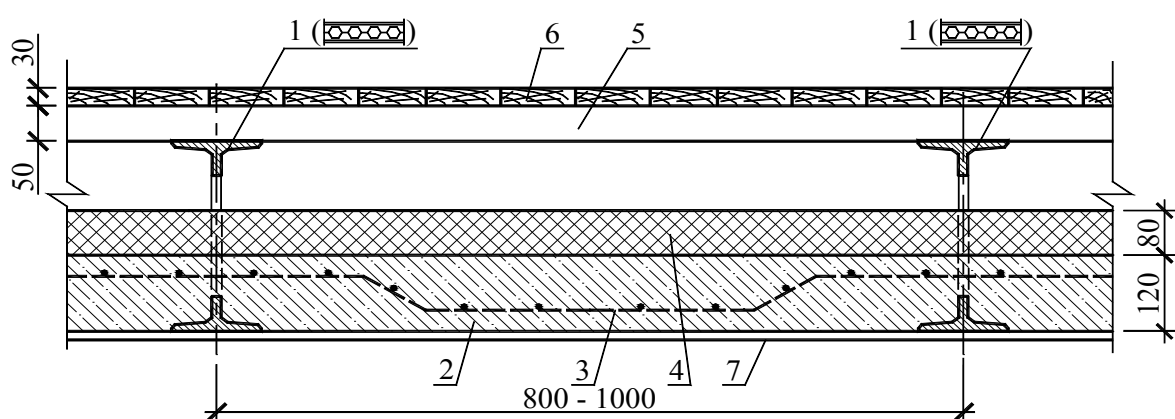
Схема межэтажного перекрытия по балкам с перфорированной стенкой: 1 – балка с перфорированной стенкой; 2 – железобетонное монолитное перекрытие; 3 – арматурная сетка; 4 – звукоизоляционный материал; 5 – деревянная лага; 6 – половая доска; 7 – отделка потолка
